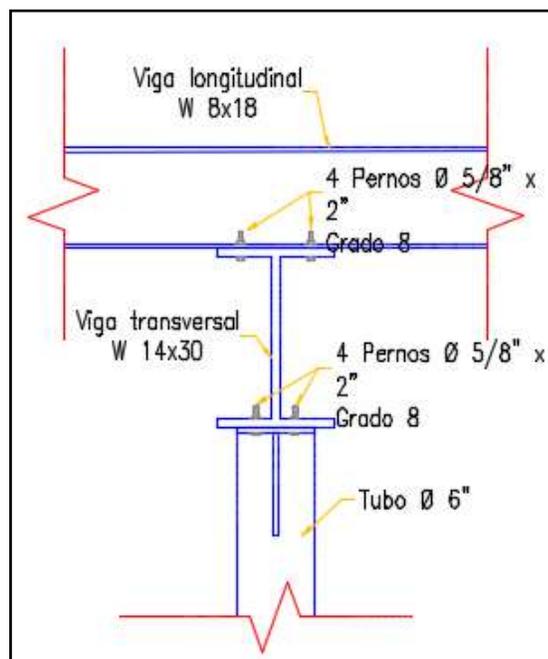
Detalle de conexión de Poste - Viga Principal - Viga Secundaria
